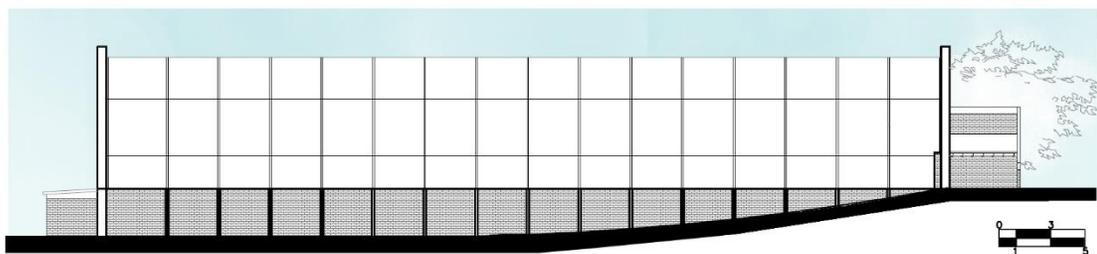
Fachada actual norte, vista desde granja infantil.
